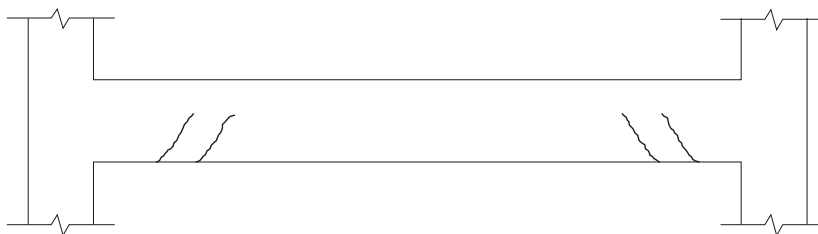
Fissuras de cisalhamento em uma viga.
